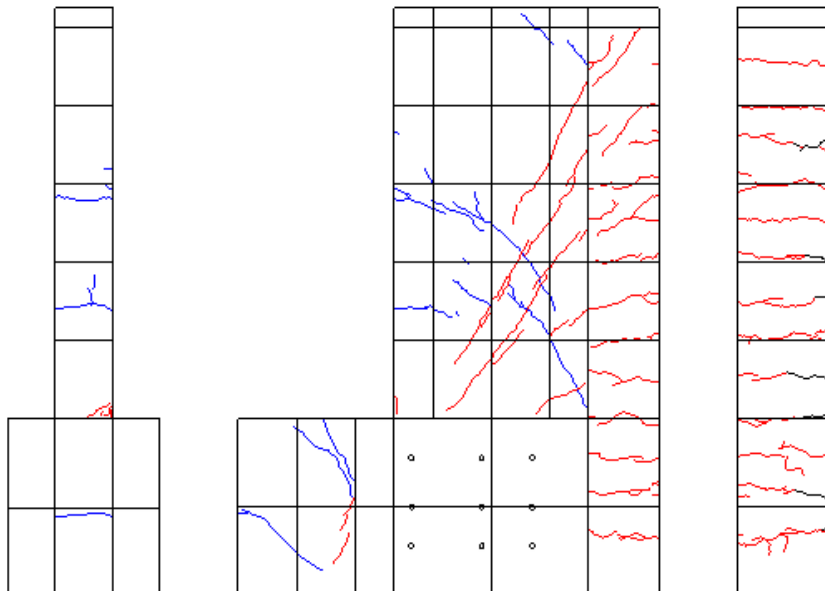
R=1/100 ひび割れ図
